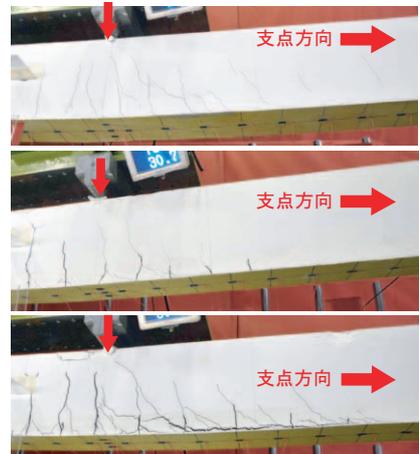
計算終局変位持近傍のひび割れ性状 (S2 梁)
